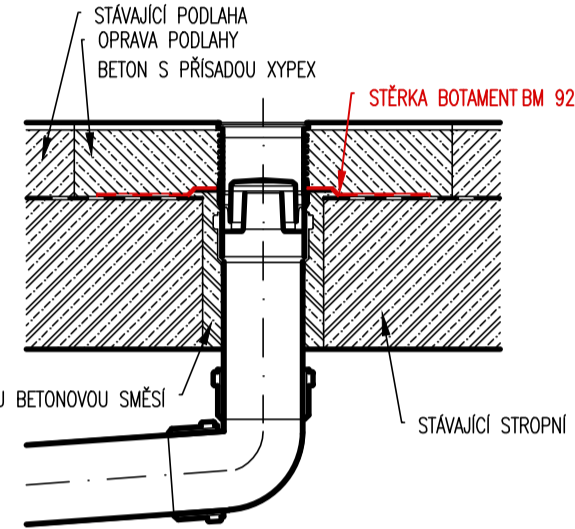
DETAIL PROSTUPŮ INSTALACÍ STROPEM V NOSNÉ STĚNĚ 1:10 – P3
